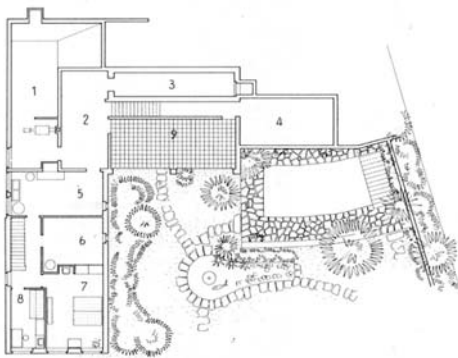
Hans Hofmann, Eigenheim, Zürich, 1940/1941, Grundriss Untergeschoss
